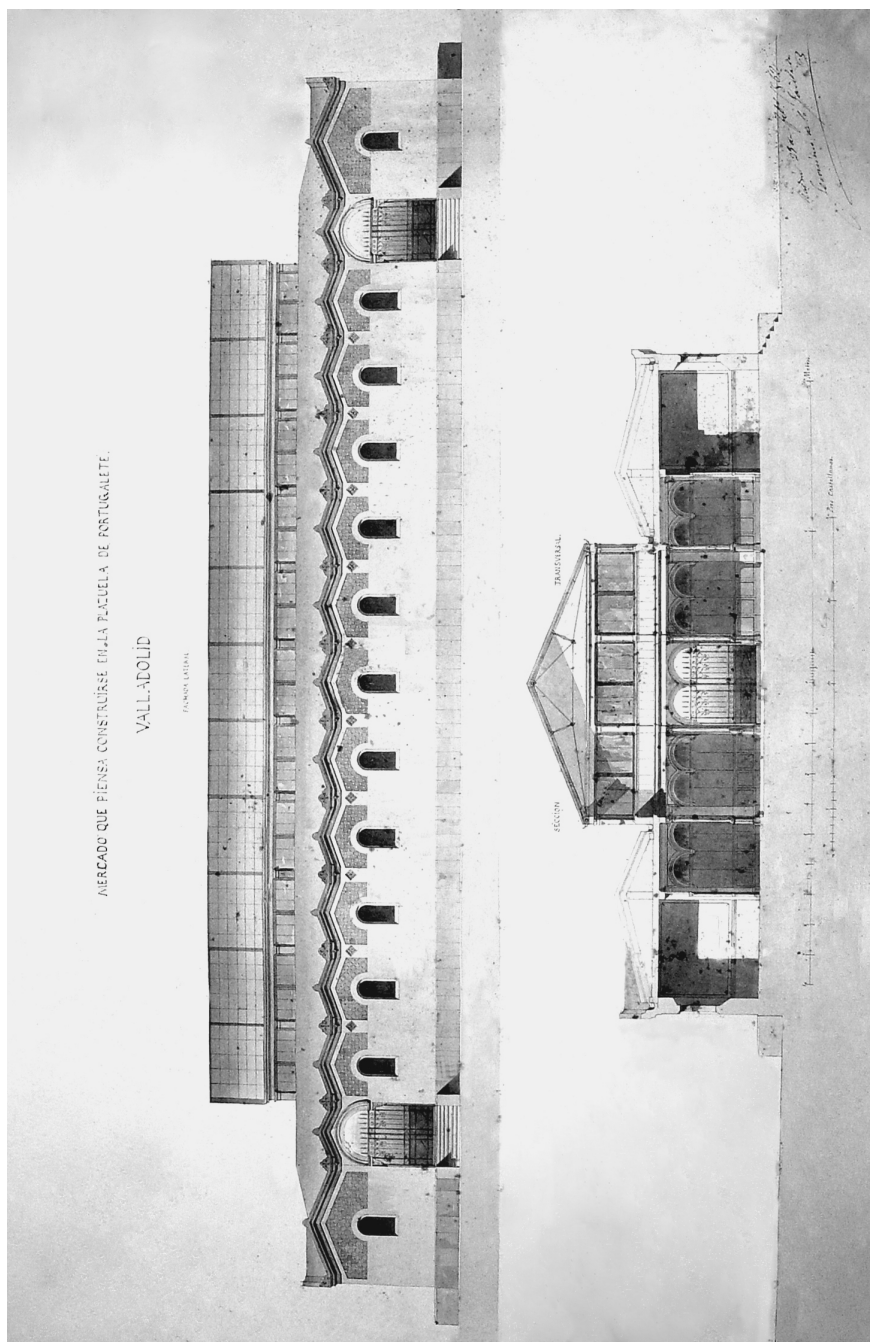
Proyecto de mercado para la plaza de Portugalete (fachada lateral y sección transversal). Jerónimo de la Gándara. 1862.
